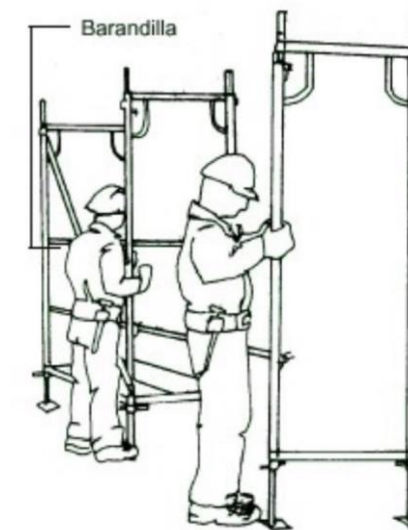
Colocación de las barandillas y el encadenamiento del andamio
